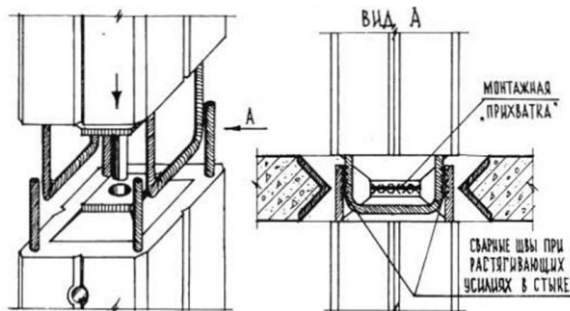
Узел наращивания сборных железобетонных колонн модификация КУБ – 2,5
